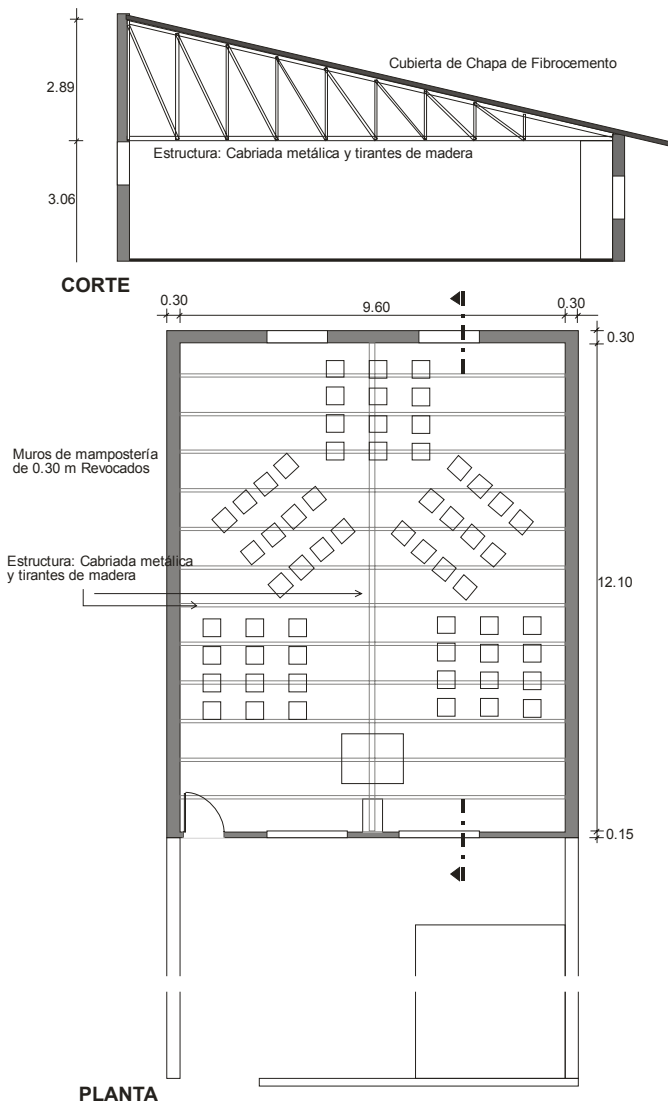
Planta y Corte según relevamiento de la sala de ensayo.
